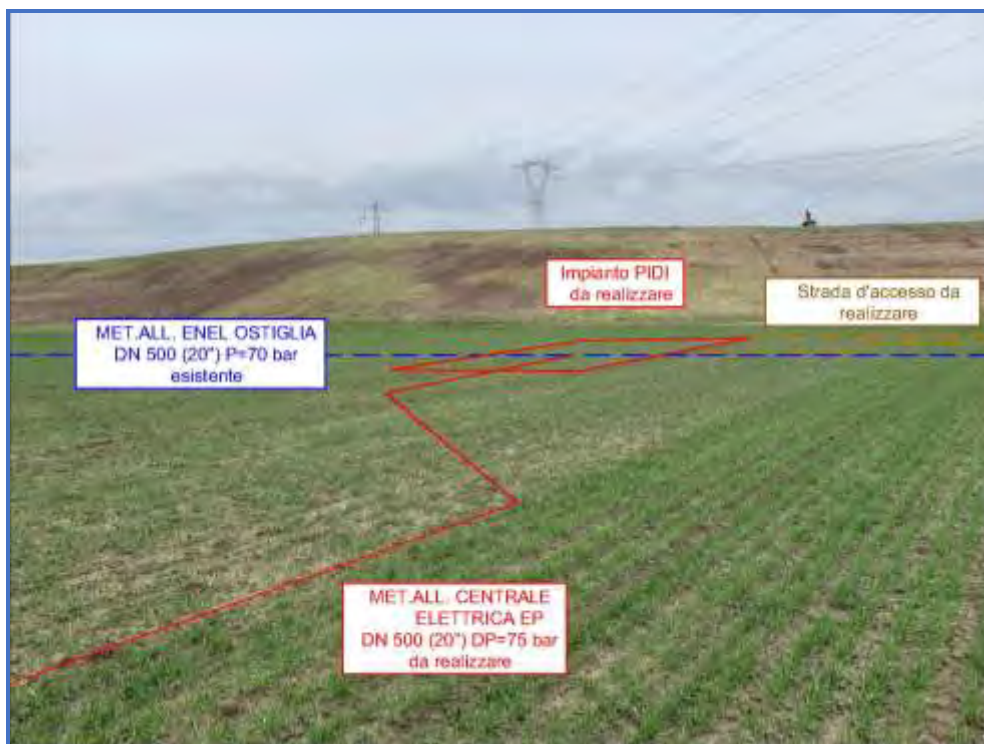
Vista dell'ubicazione dell'impianto P.I.D.I. e del metanodotto in percorrenza nel terreno.
